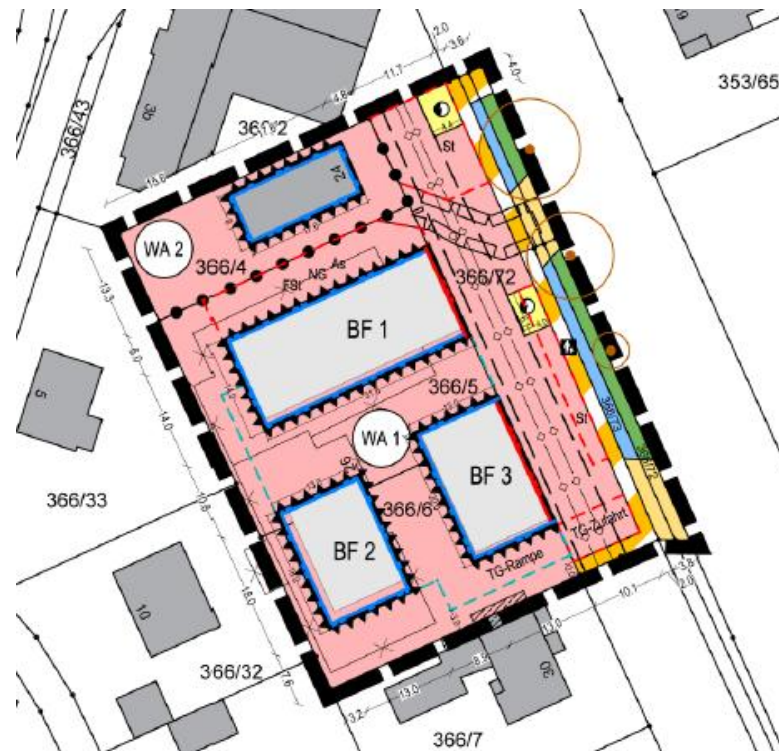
Planzeichnung Bebauungsplan Nr. 114
